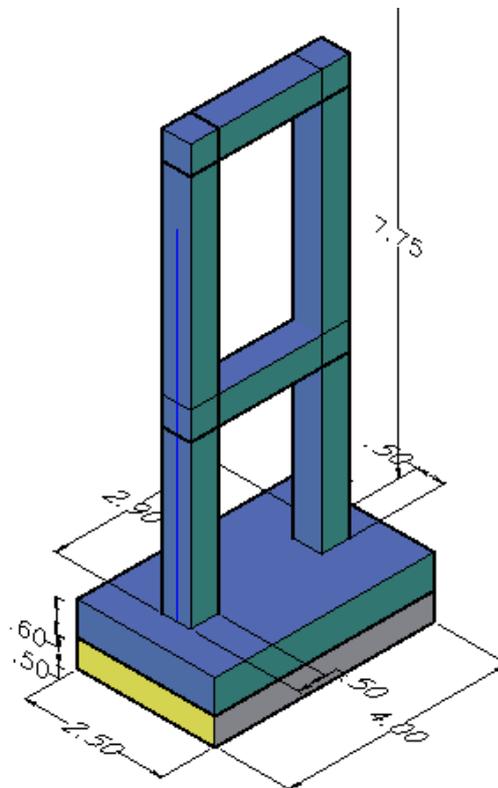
Estructuras de las torres de suspensión – Lado Izquierdo (Fuente: Propio)
